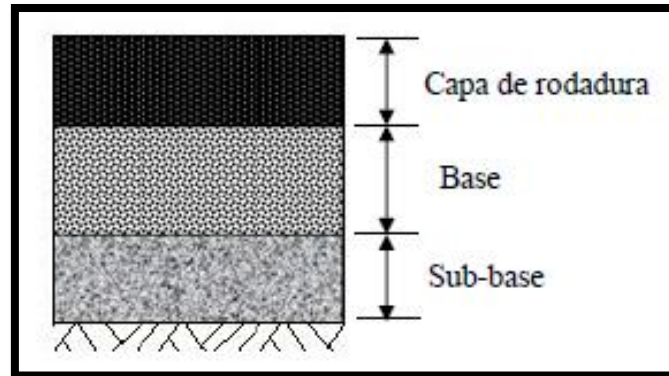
Capas del pavimento flexible (Bilbao, 2014).
